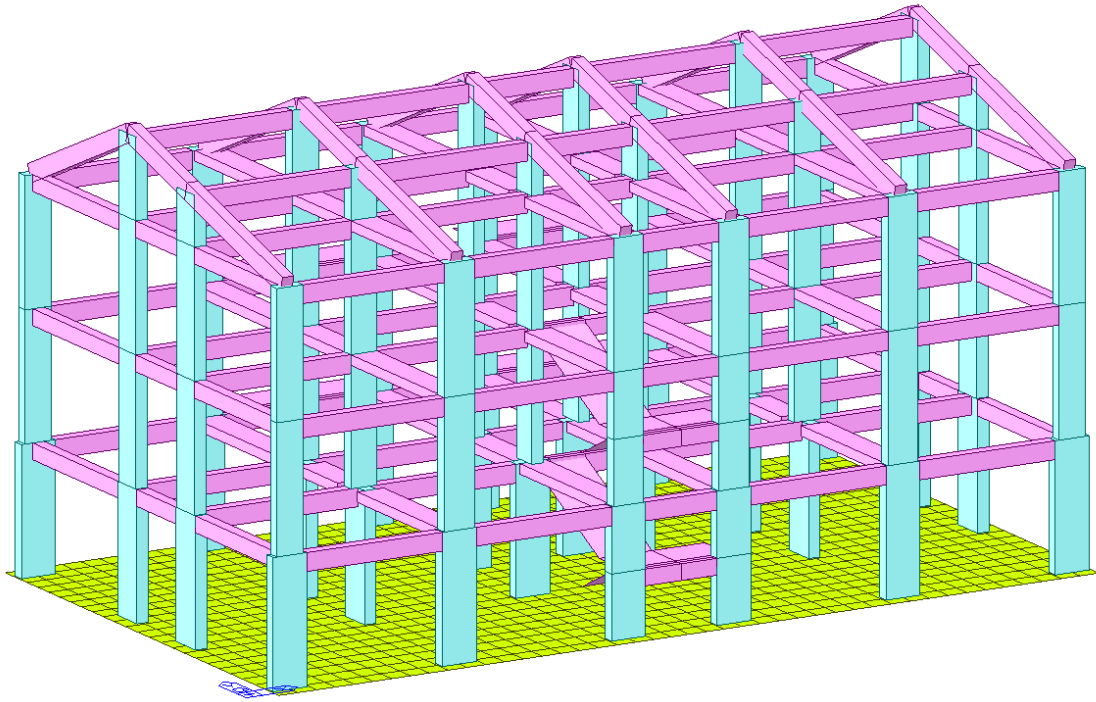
Modello FEM edificio a tre piani in c.a. con platea di fondazione - Vista assonometrica 1.
